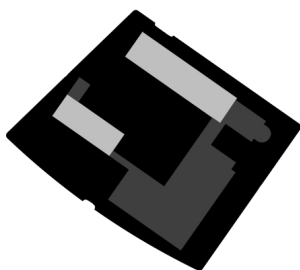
Esquema da planta de implantação da Escola Secundária Sebastião da Gama, em Setúbal.
